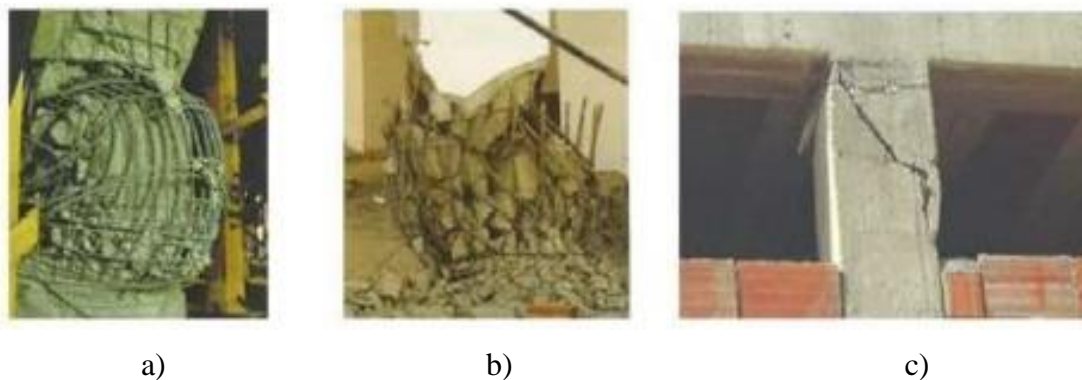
Danos estruturais devia a má pormenorização: a) e b) cintagem inadequada de pilares; c) formação de pilares curtos e deficiente cintagem; adaptado de Silva (2015)
